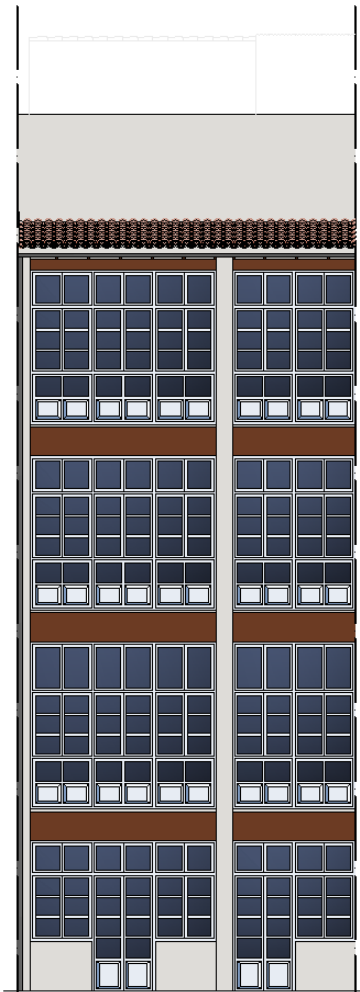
Levantamiento planimétrico fachada posterior Sorní n°14. Fuente propia.
